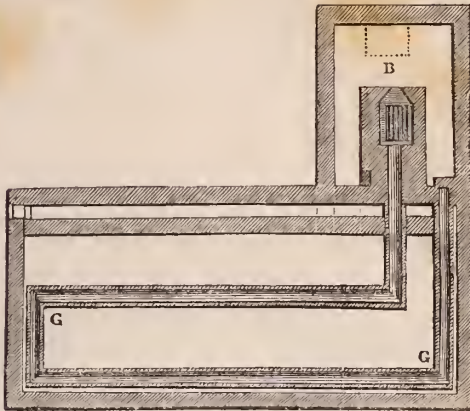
Plan d'une chaudière pour le chauffage à la vapeur.
